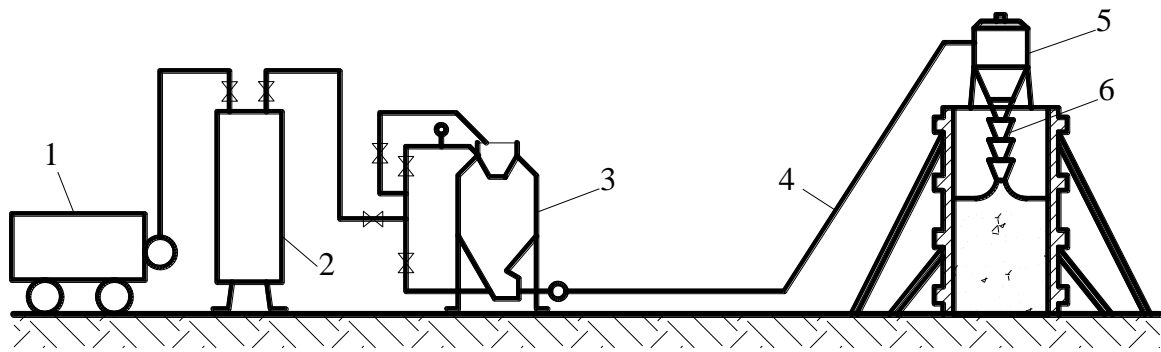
Схема бетонування за допомогою пневмонагнітання:
